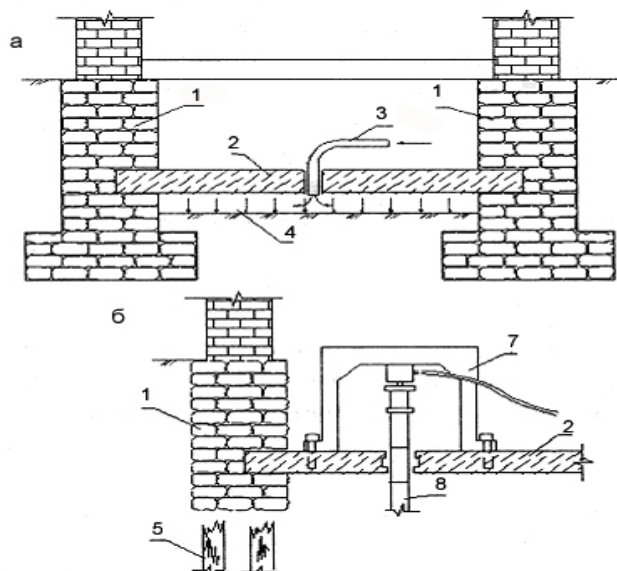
Увеличение опорной площади с помощью монолитной железобетонной плиты: *а* – с опрессовкой грунта; *б* – с подведением многосекционных свай вдавливания; 1 – существующий фундамент; 2 – железобетонная плита; 3 – труба для инъекции расширяющегося цементного раствора; 4 – цементный раствор между плитой и грунтом; 5 – сгнившие деревянные сваи; 6 – домкрат; 7 – опорное коромысло; 8 – вдавливаемые сваи
